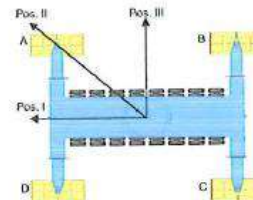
determinazione della posizione del braccio e delle piastre d'appoggio
